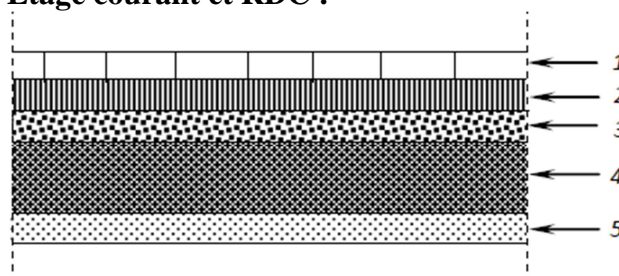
Coupe verticale d'un plancher d'étage courant
